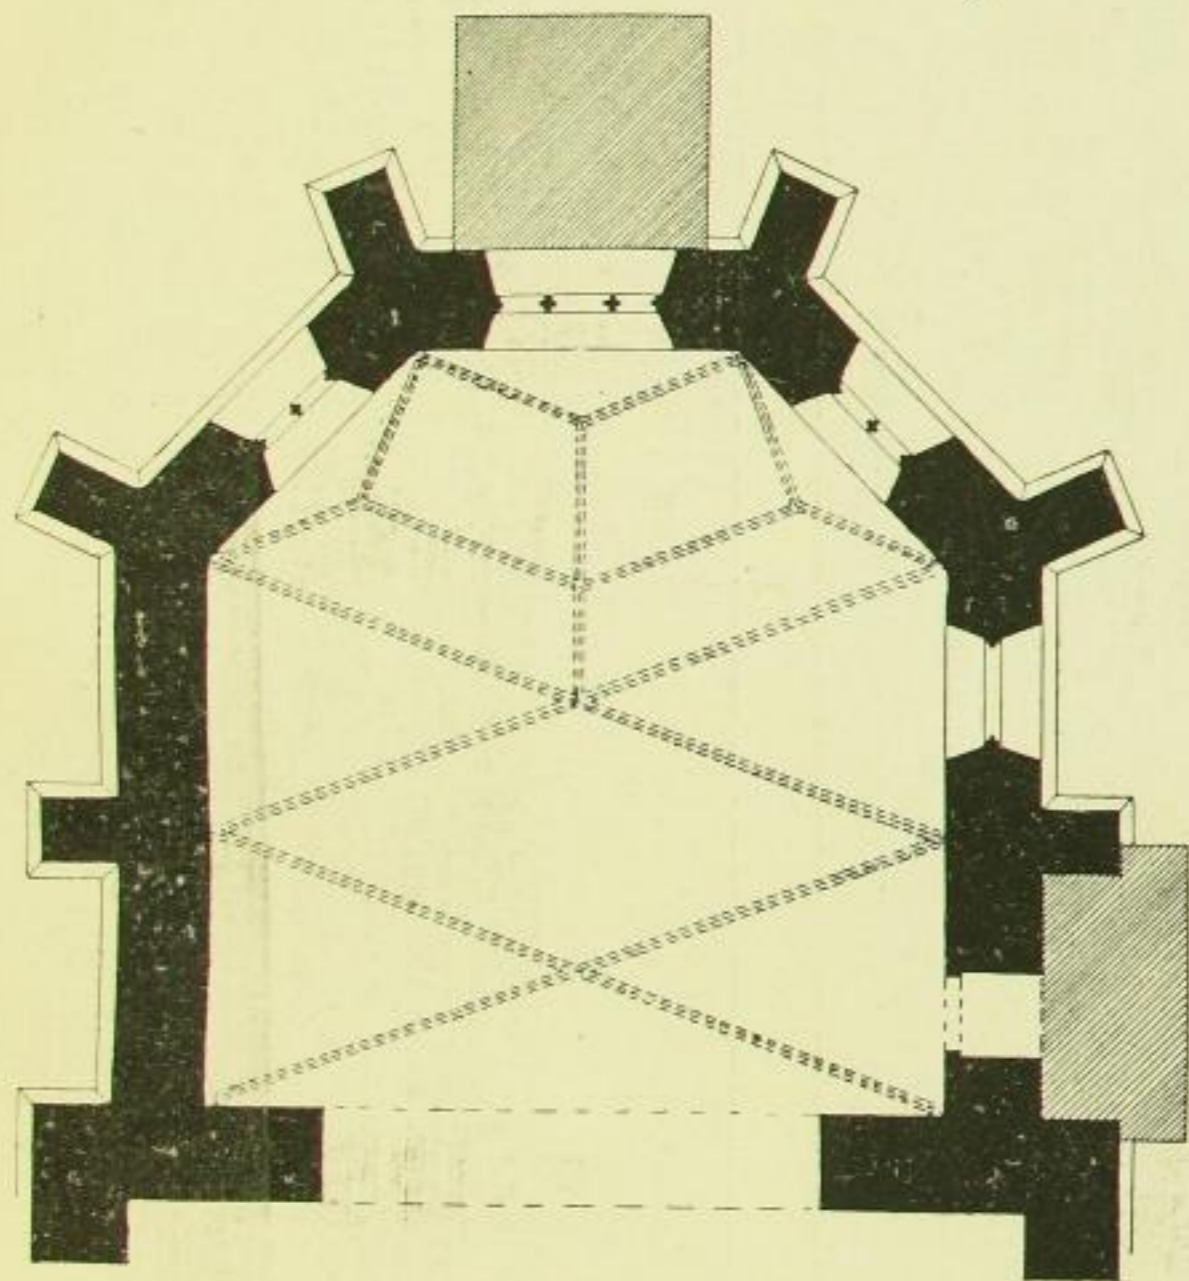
Mohorn, Grundriss des Kirchenchores.
